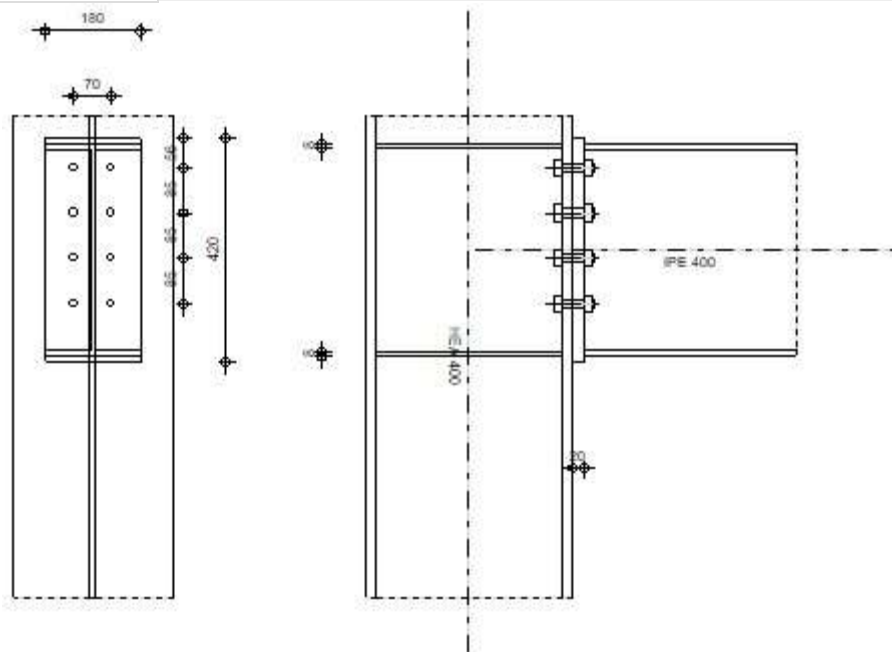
Représentation de l'assemblage Poteau de rive – poutre maitresse.
